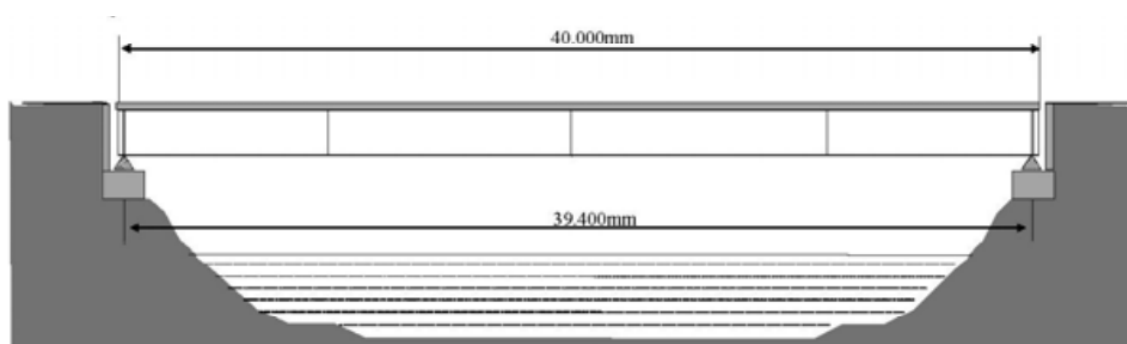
Exemplo de seção transversal de ponte mista de concreto armado e longarinas de aço
